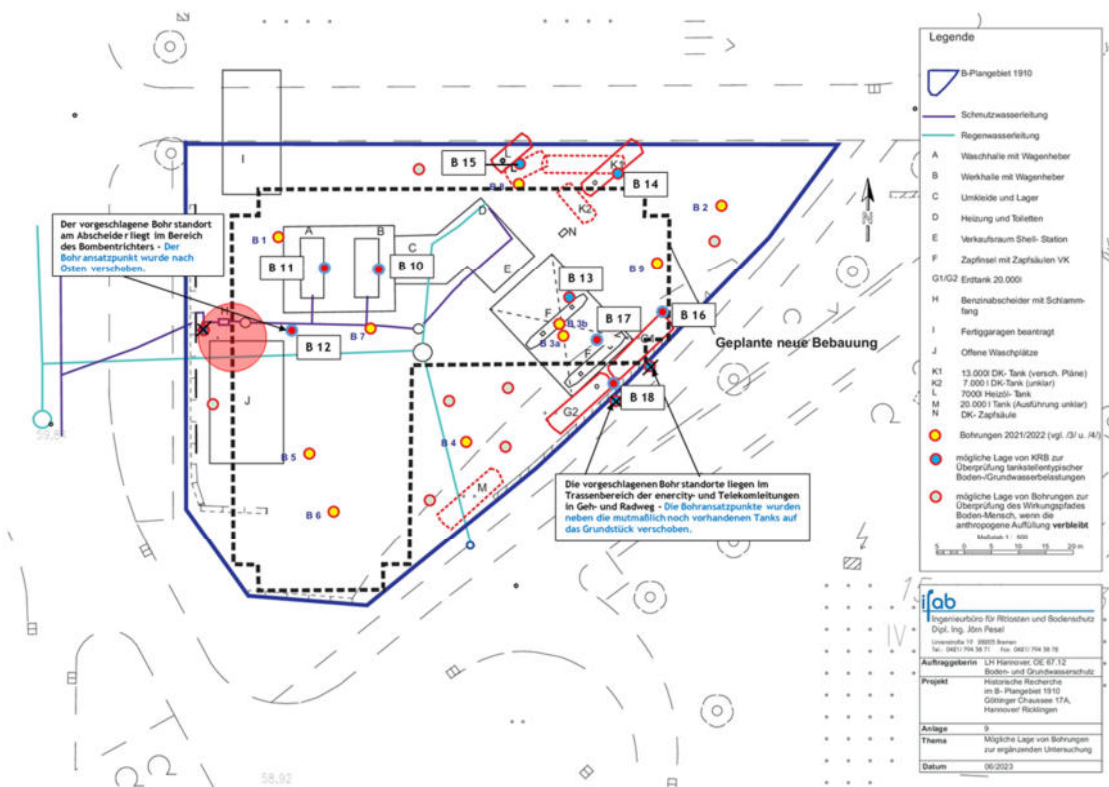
Bohrprofile und Lageplan der Bohransatzpunkte der ergänzenden Erkundungen vom August 2023
